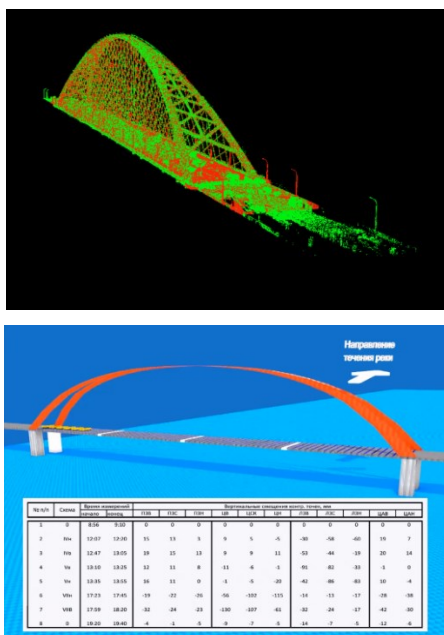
Монтаж и испытания пролетов Бутринского моста
